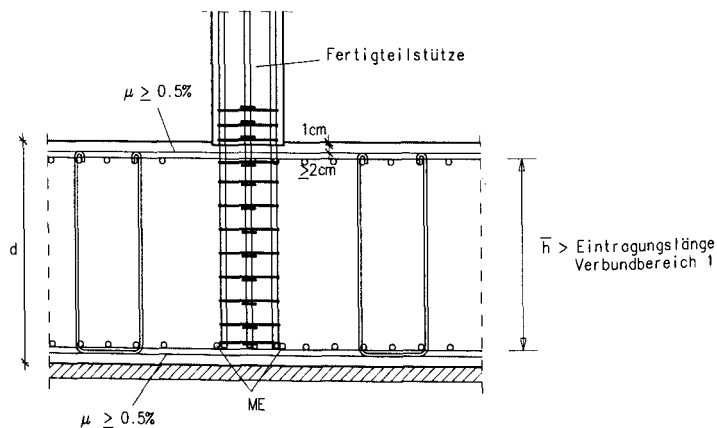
Konstruktive Ausbildung mit Überstand der Stützenbewehrung
